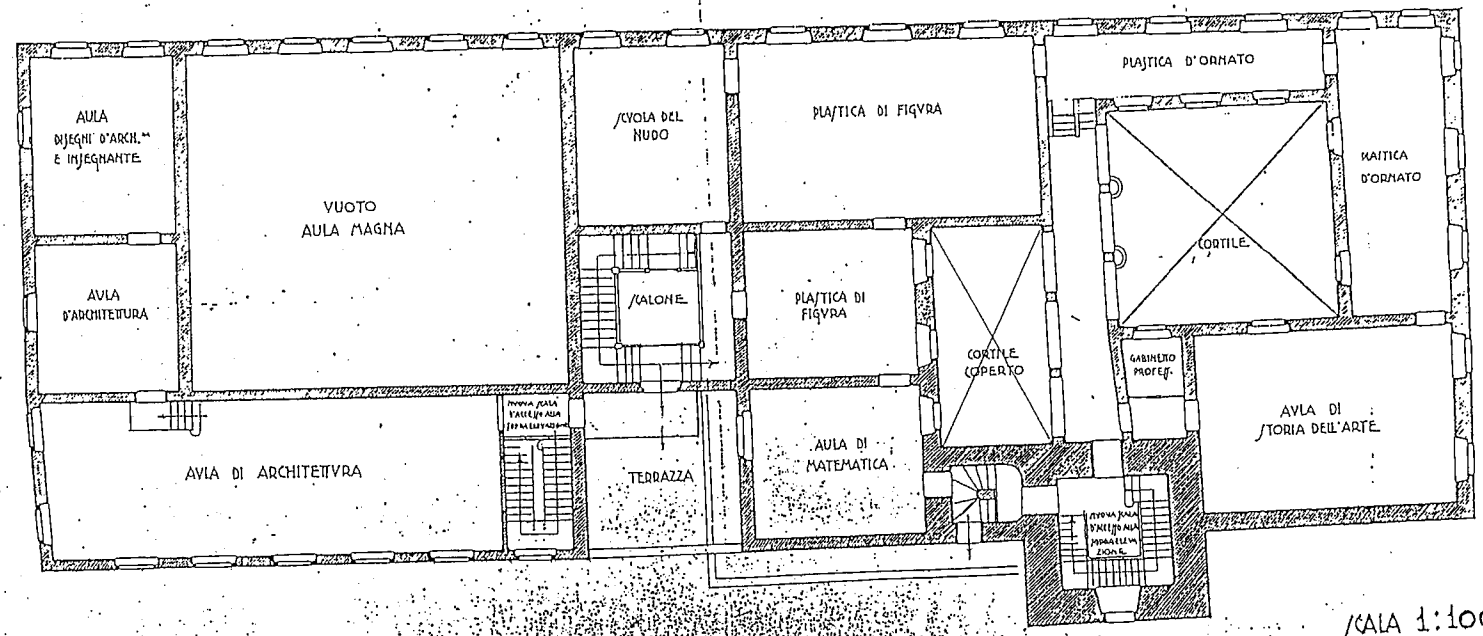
E. REMEDI, PIANTA PIANO SECONDO (1953), SC. 1:100.
